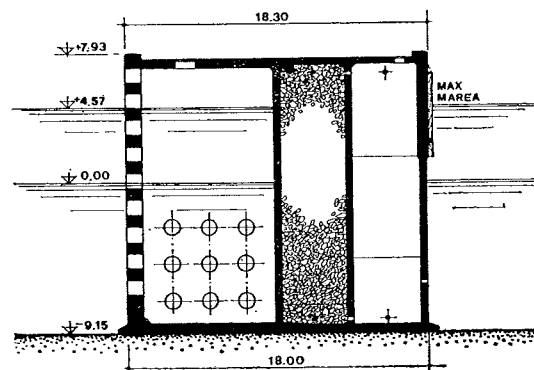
Diga a fori (Jarlan) a Baia Comeau (Canada).
